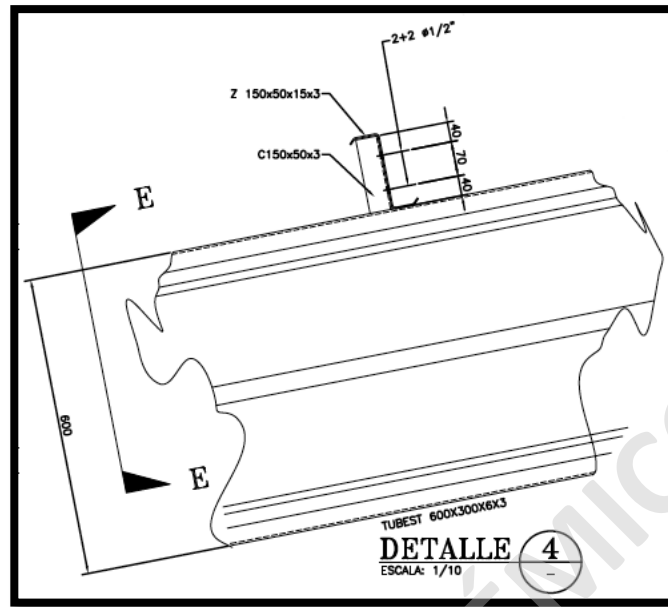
Detalle de Costanera de Cubierta ODR Ingeniería y Montaje.
